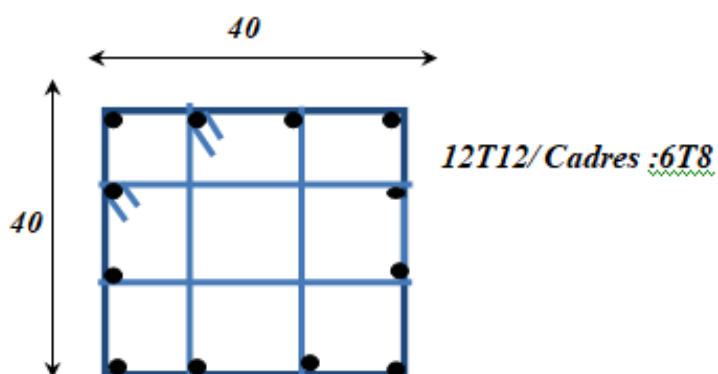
Schéma de ferrailage des poteaux 40×40.
